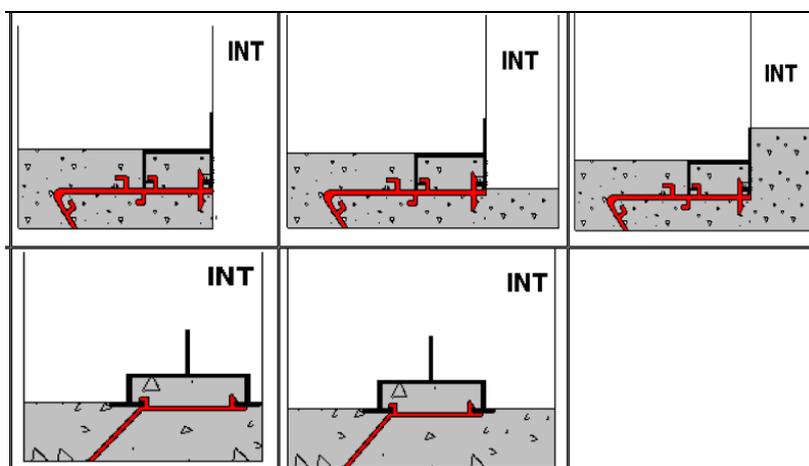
Detalhe da instalação de peças de fixação na alvenaria
